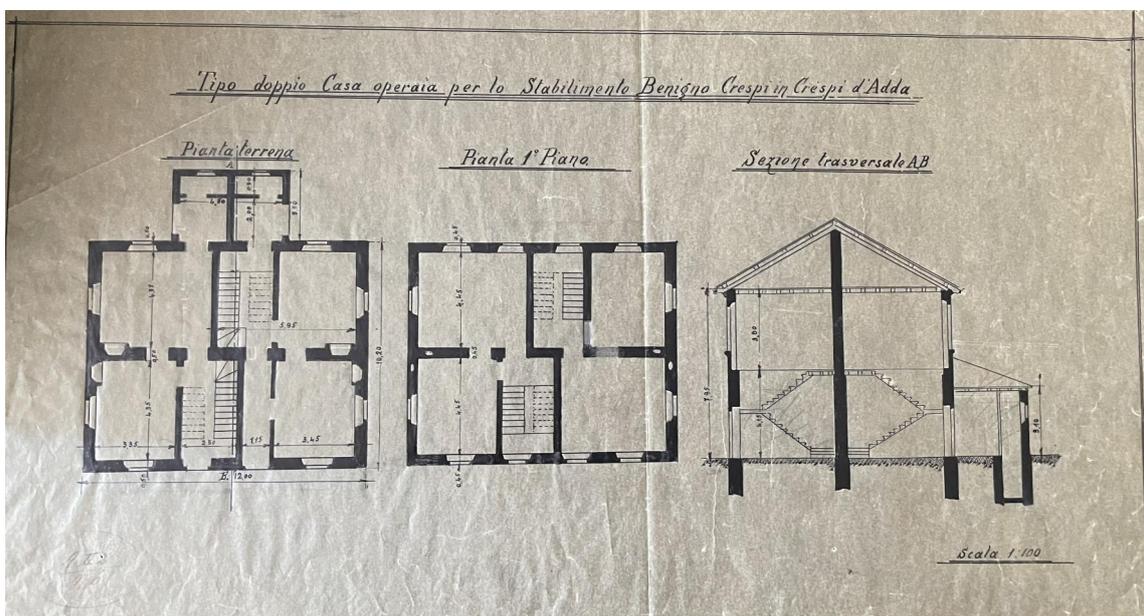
, Planimetria casa operaia, Archivio Storico di Crespi d'Adda, sezione 4.5.2
